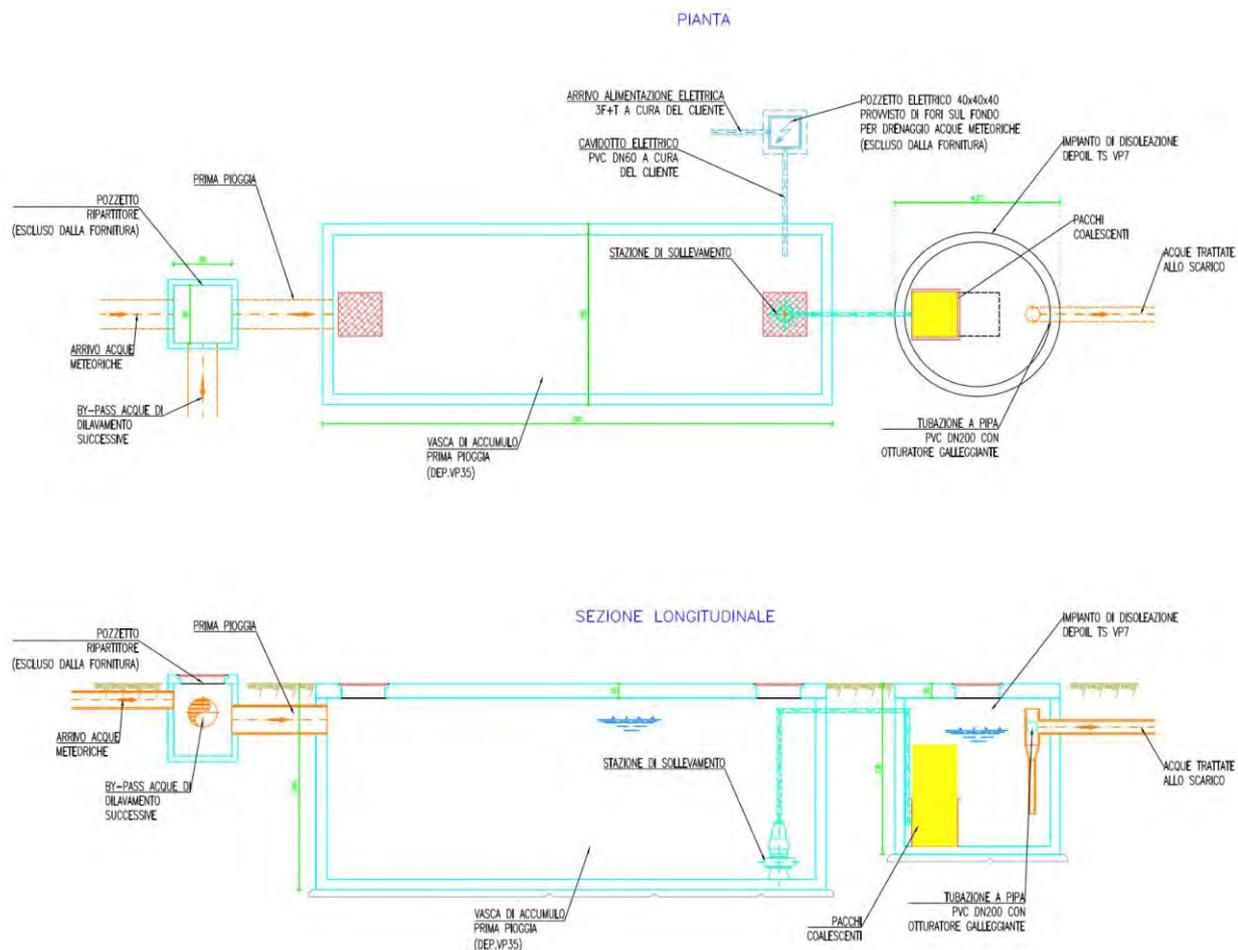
Pianta e sezione del nuovo impianto di trattamento prima pioggia
